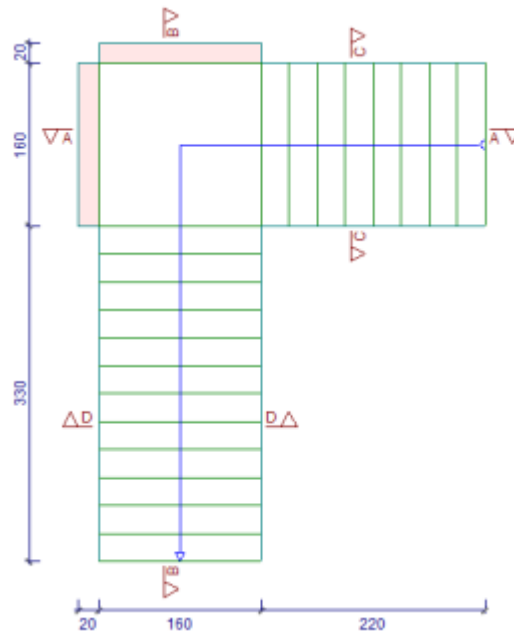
Vista en Planta de la escalera, Fuente: CypeCad 2107
